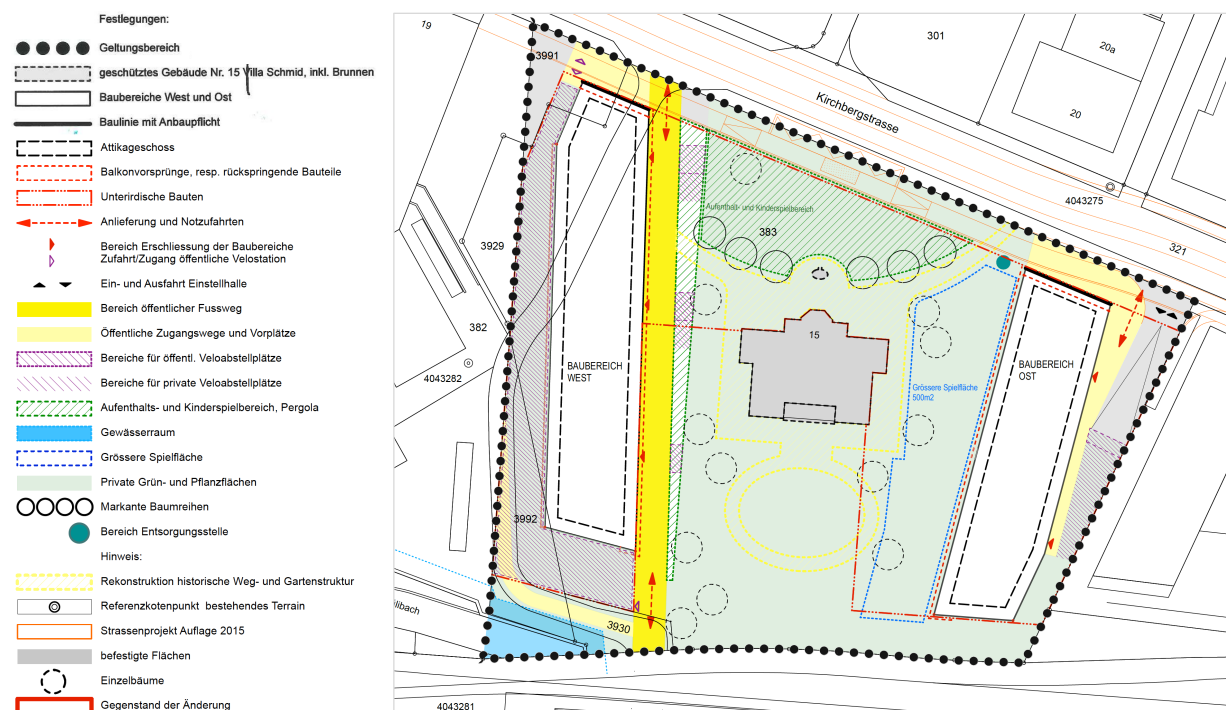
Rechtskräftiger Überbauungsplan, genehmigt 26. Mai 2020
